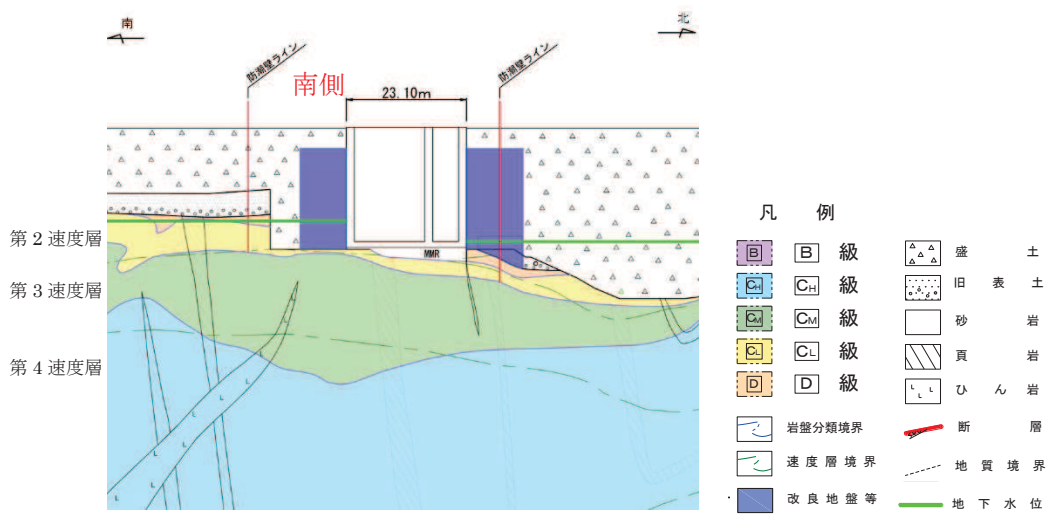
第3号機放水立坑地質断面図 (B-B断面)
